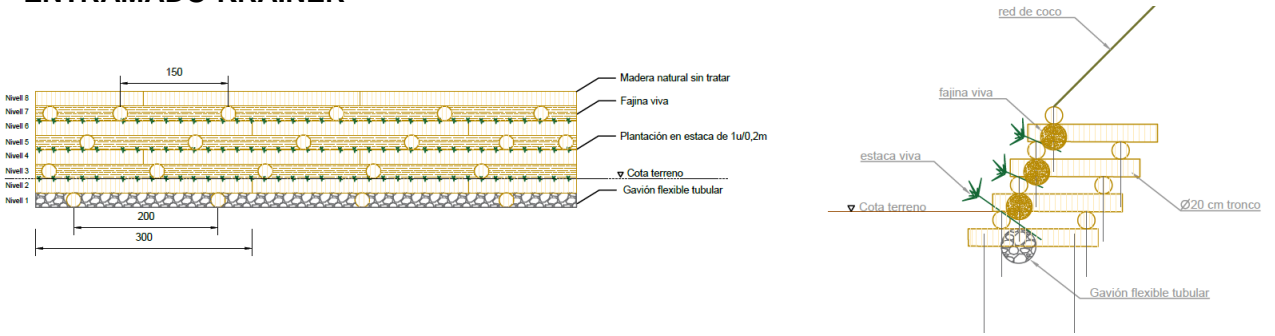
Detalle constructivo y ejemplo de entramado Krainer
